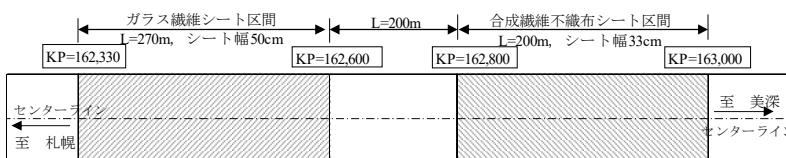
低温ひび割れ補修箇所の平面図
